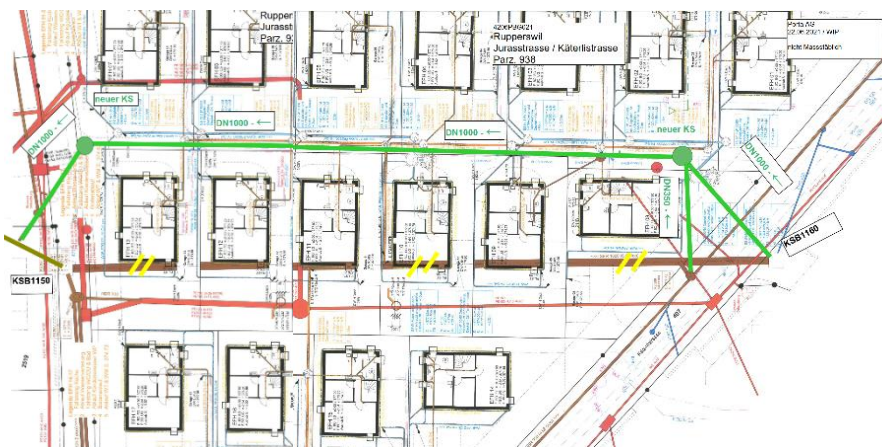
Planausschnitt Bauvorhaben, projektierte Kanalisation in Grün (Variante Ost)
